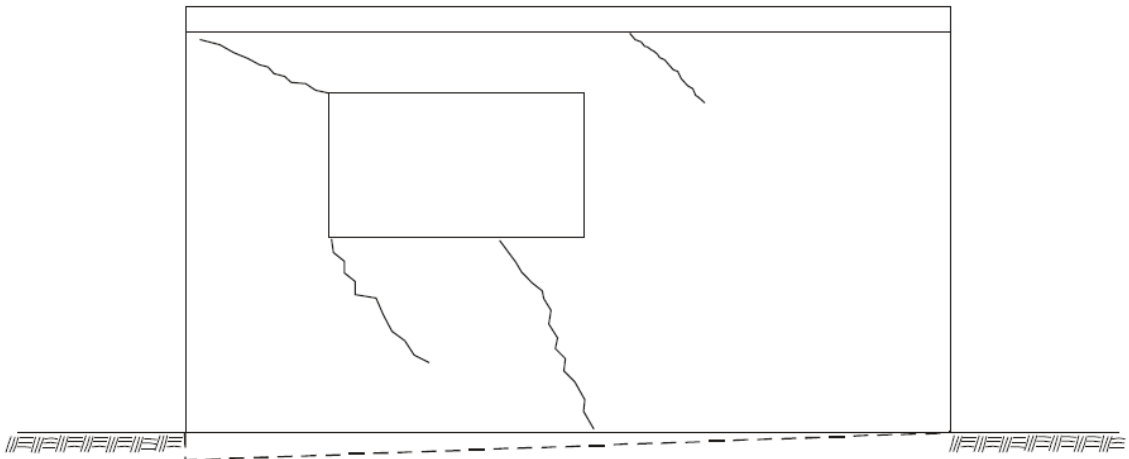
Fissuras originárias de recalque diferencial do solo de fundação.
